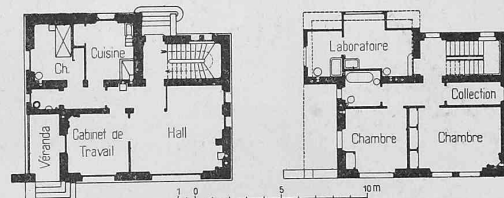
et 34. Plans du rez-de-chaussée et du premier étage de la villa de M. Reiss en Paumaz près Lausanne. — Echelle 1 : 400.
